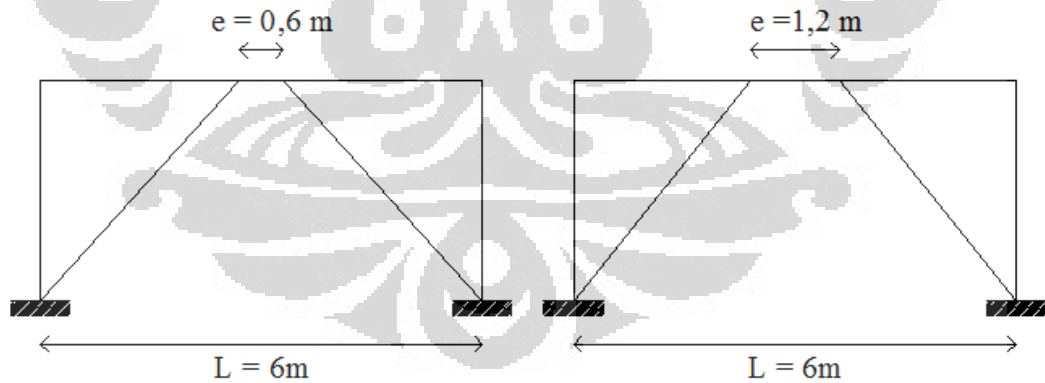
Denah Bangunan dan Portal yang Ditinjau
